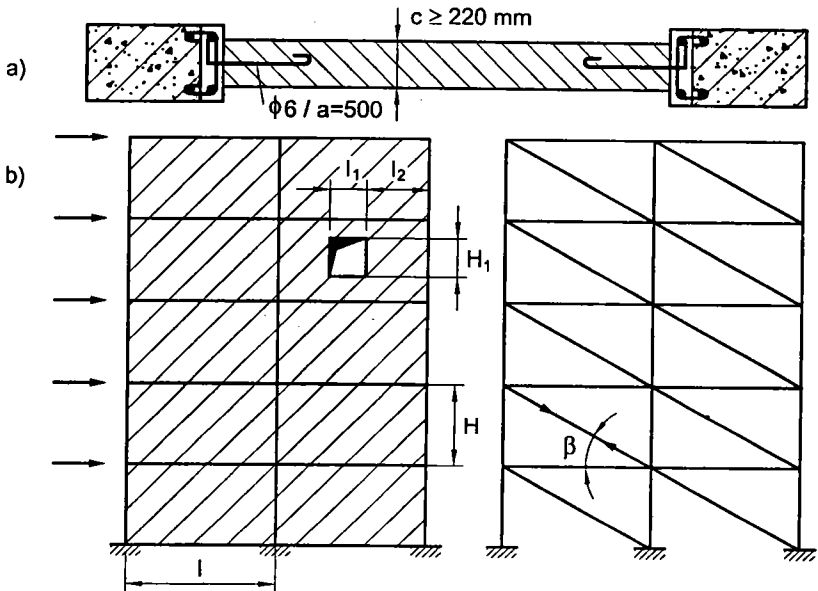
Cấu tạo vách cứng bằng bê tông cốt thép
